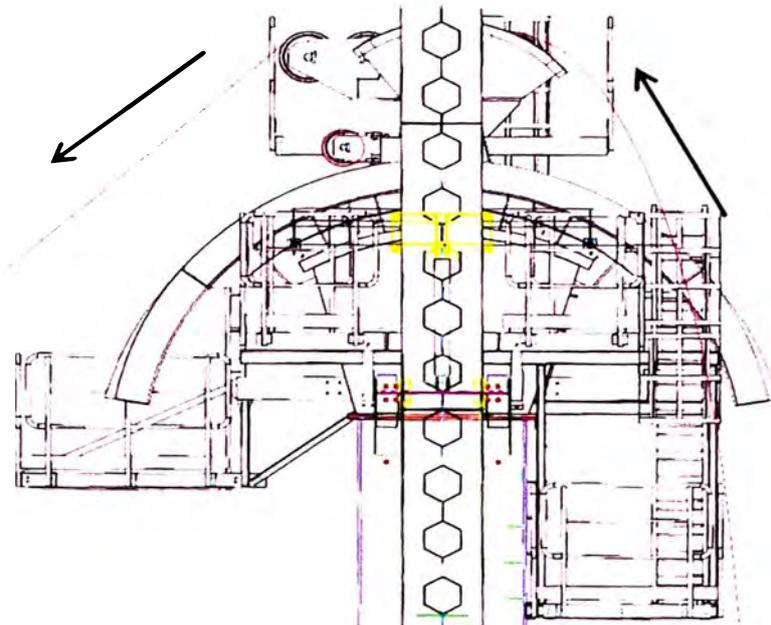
ESQUEMA DEL TRASLADO DE CABLE DEL PILÓN AL
